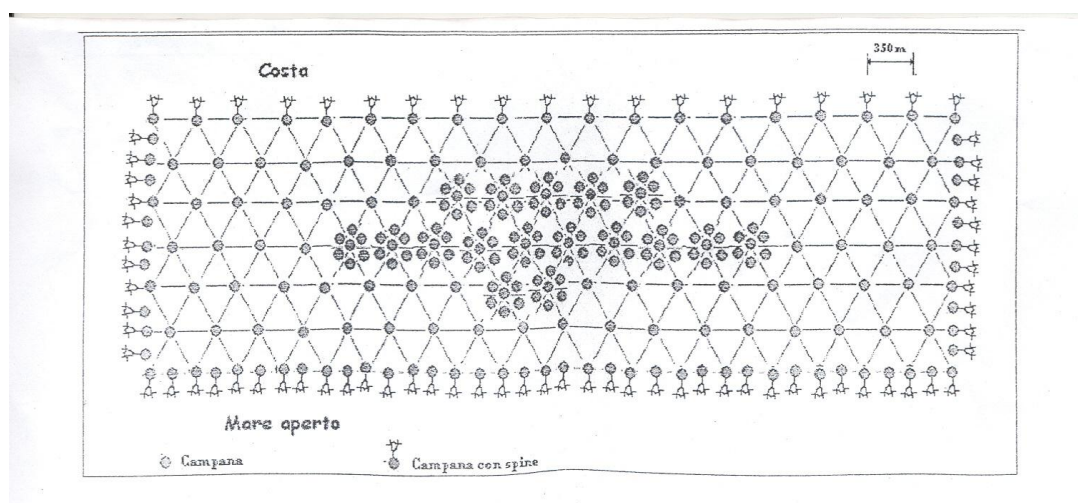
Disposizione a “quinconce” delle campane in calcestruzzo.
